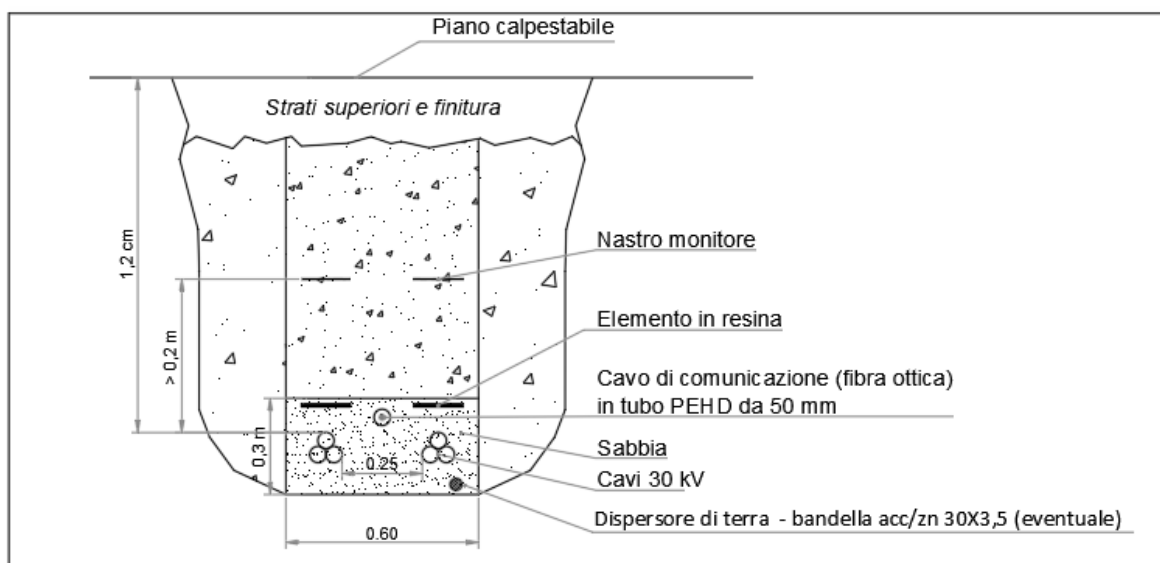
Sezione cavidotto a 30 kV collegamento verso SE produttore
